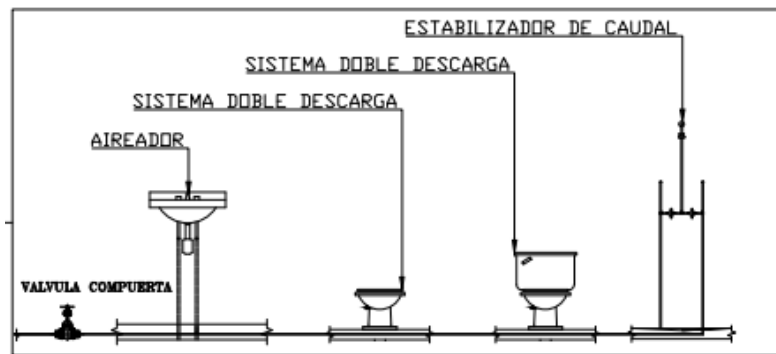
Ubicación de dispositivos en la planta tipo (Caso estudio).
